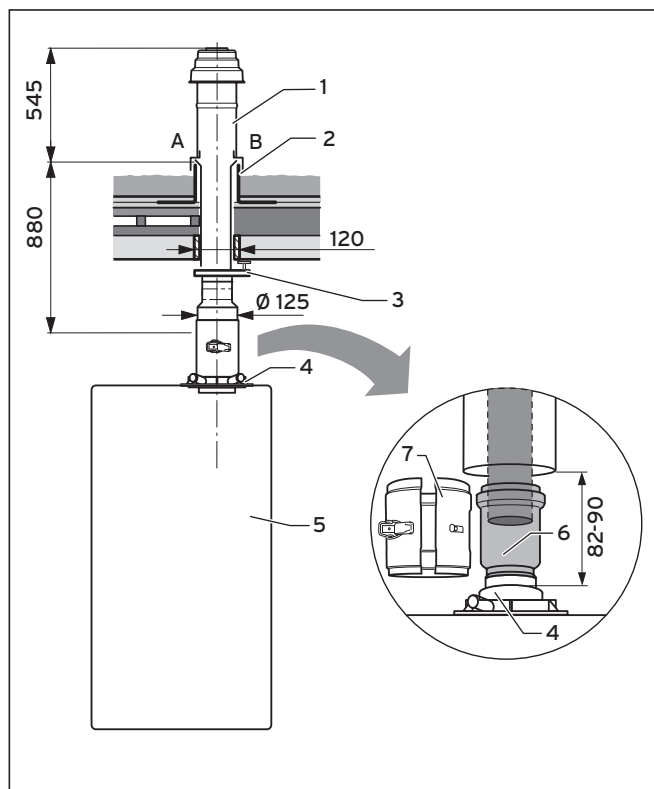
Montage de l'appareil et de la traversée pour toits plats
